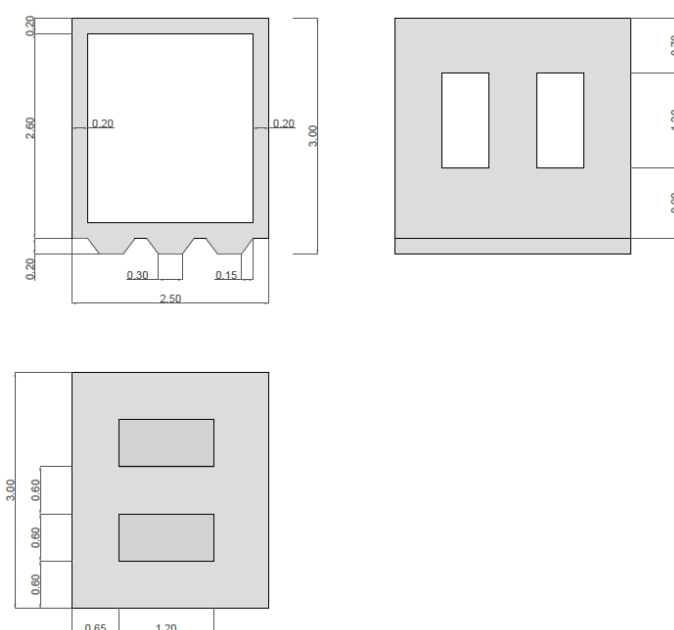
Diseño y dimensiones de las piezas. (Fuente: plano 7, 2023)
